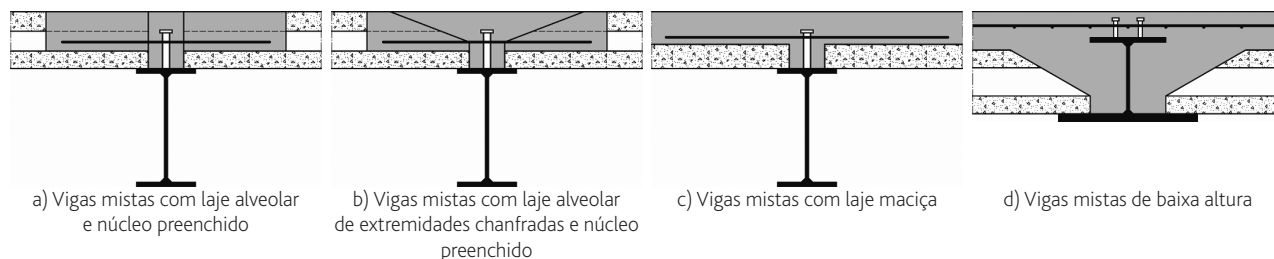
Secções transversais tipo em vigas mistas com lajes pré-fabricadas [6]
